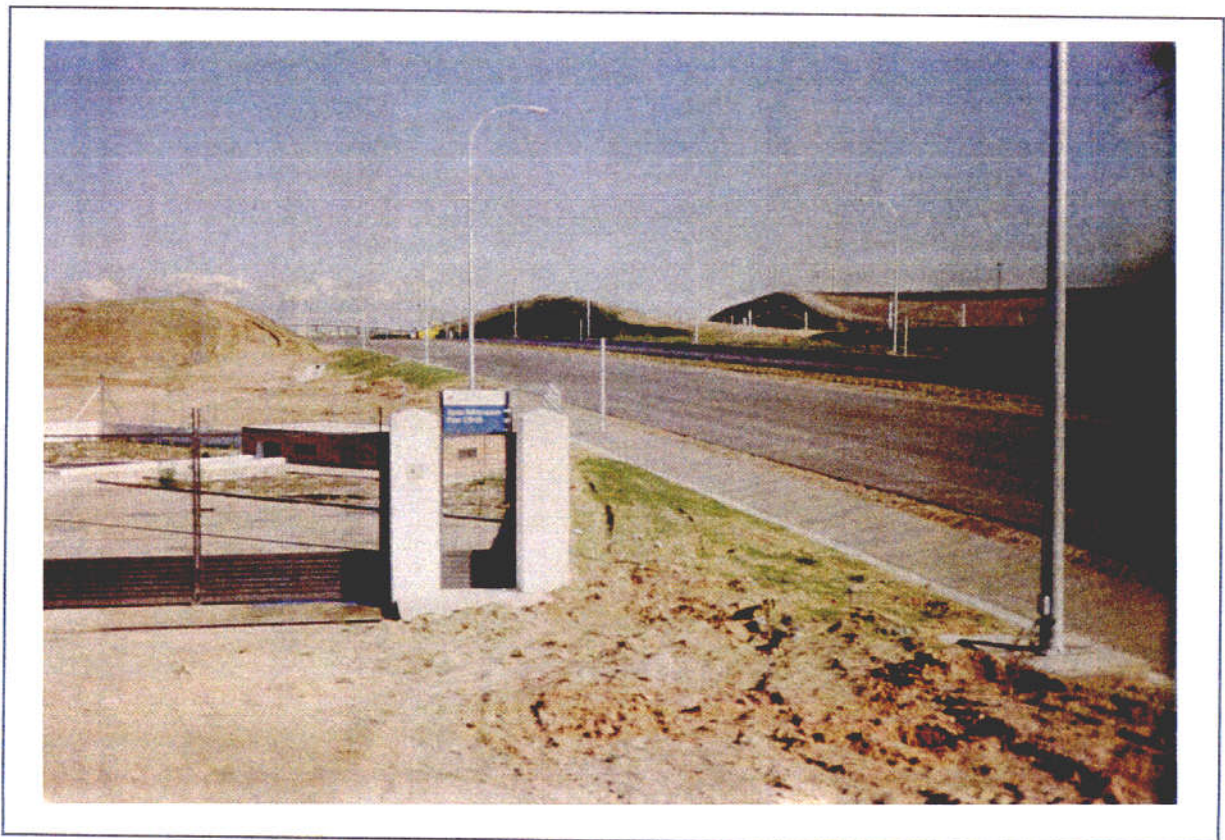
Vista del sondeo. Las obras de la m-40 están casi finalizadas (otoño 95).
